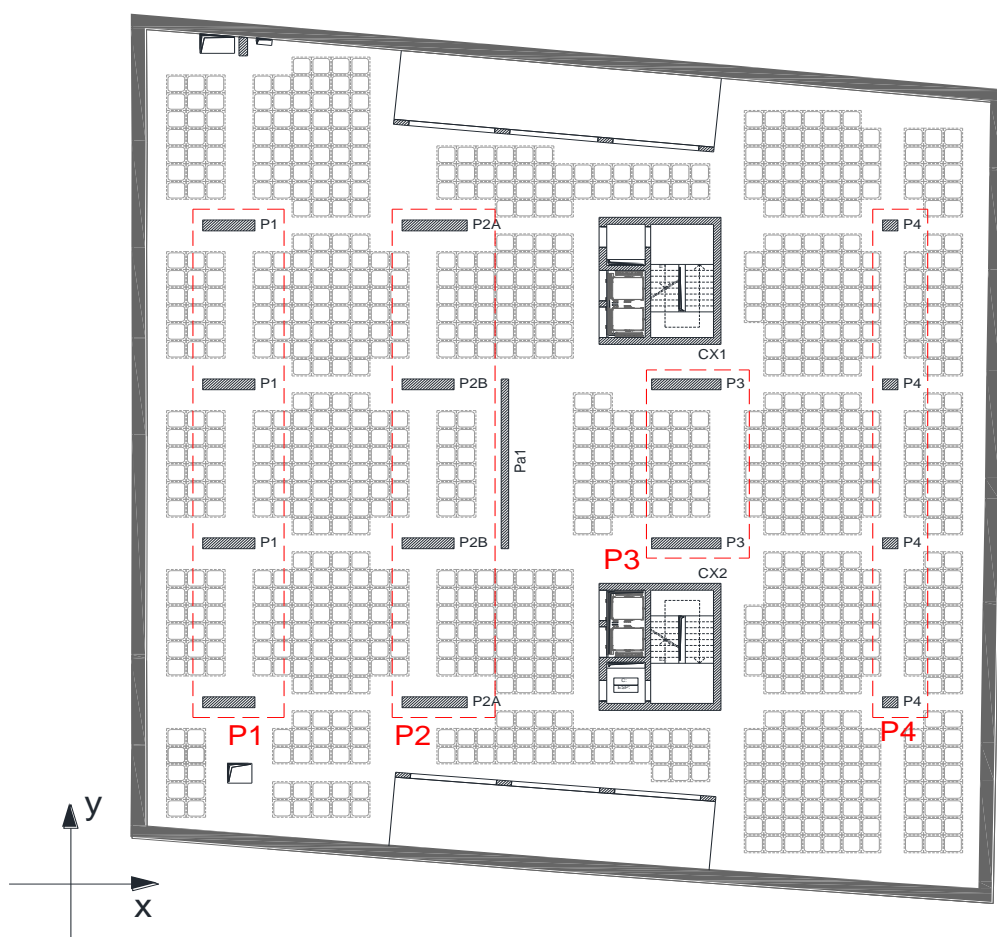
Planta estrutural dos pisos enterrados – identificação dos elementos verticais
